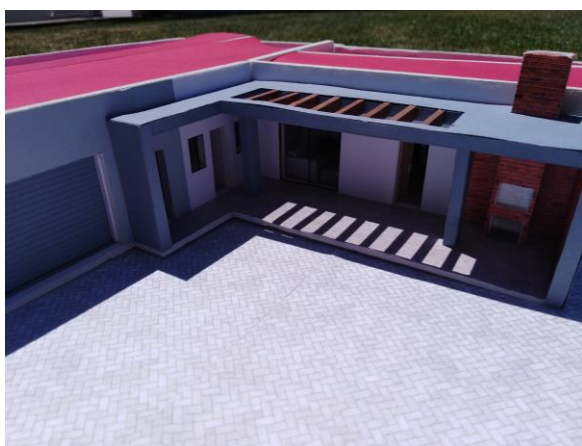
Maquete: vista da fachada posterior (maio de 2020). Fonte: Autor.
